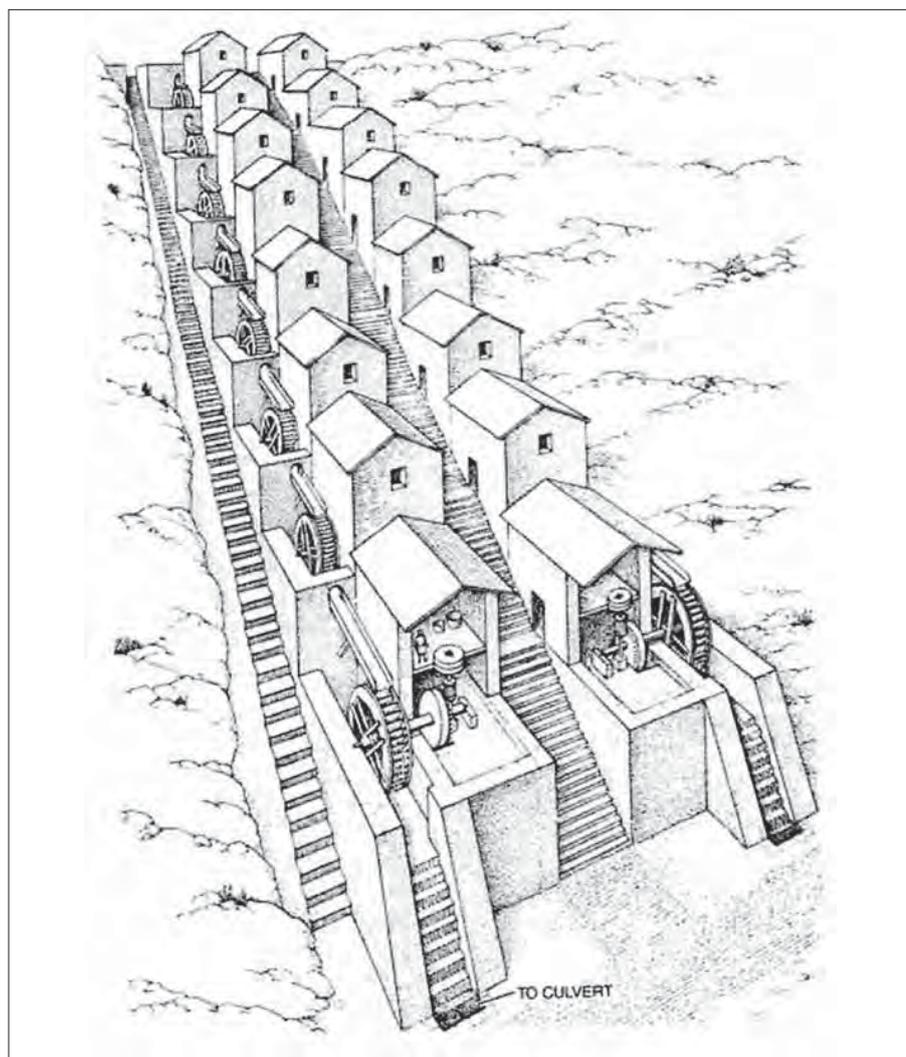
Altra ricostruzione dell'impianto (Viollet, 2000)
